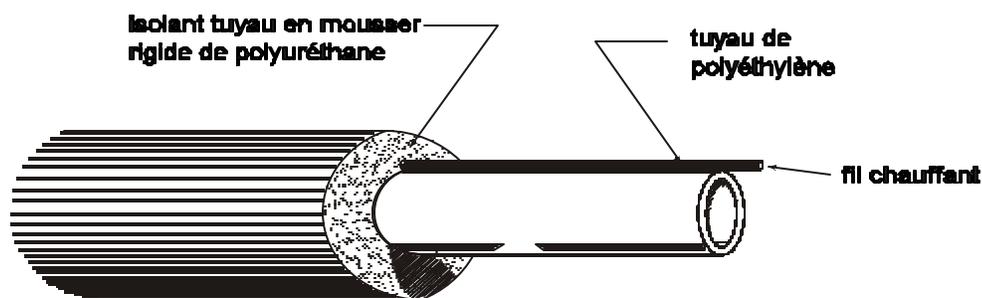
Conduite principale pré-isolée avec câble chauffant.
